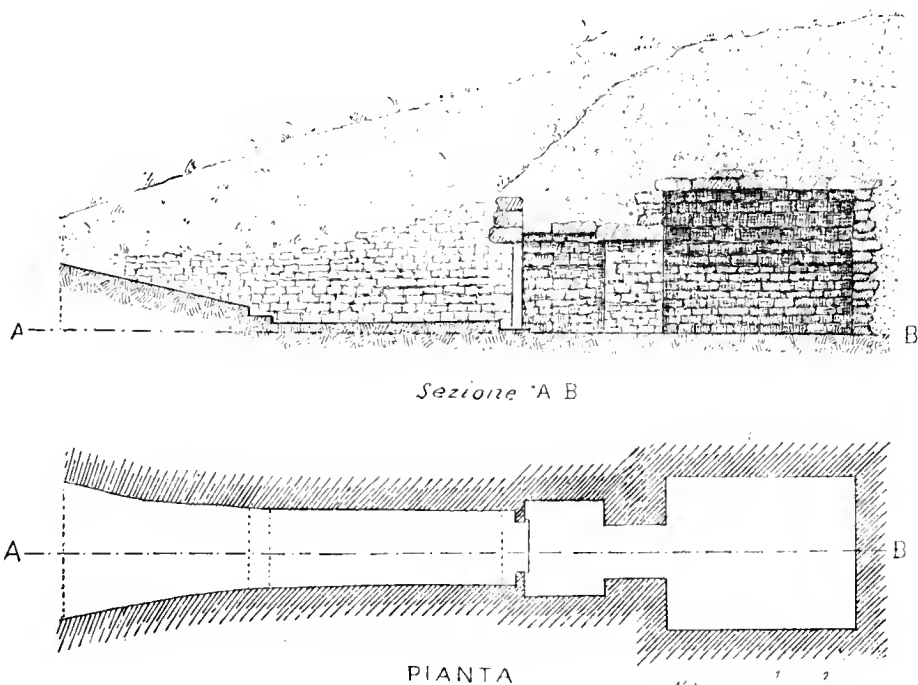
Pianta e sezione dell'ipogeo settentrionale.
